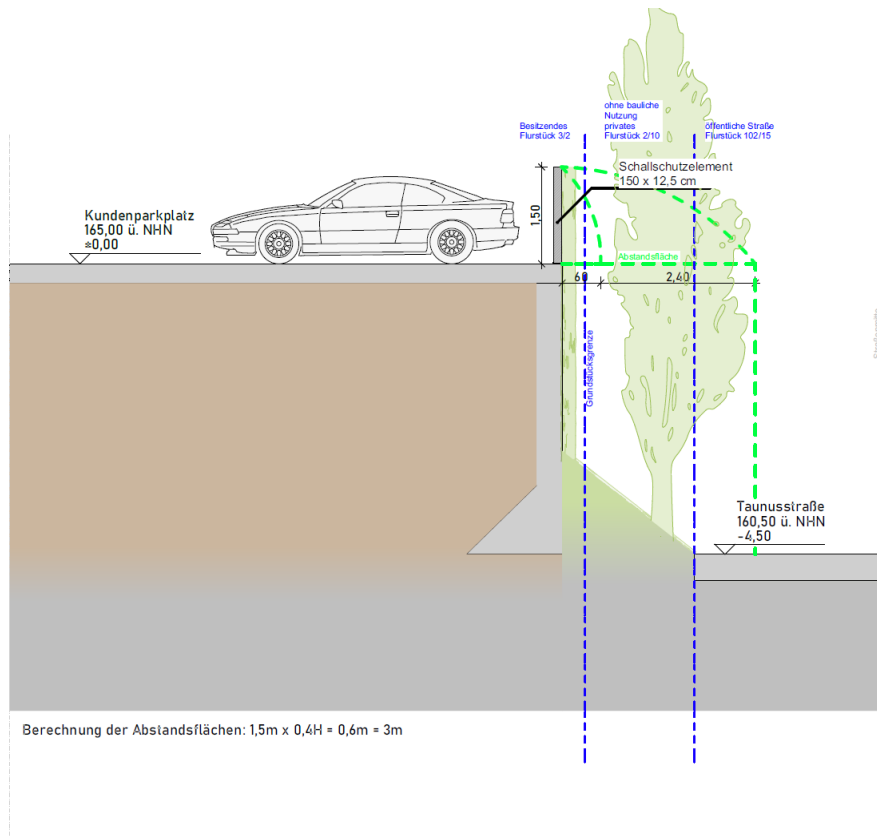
Vorabzug Schnitt mit Darstellung der geplanten Lärmschutzwand
